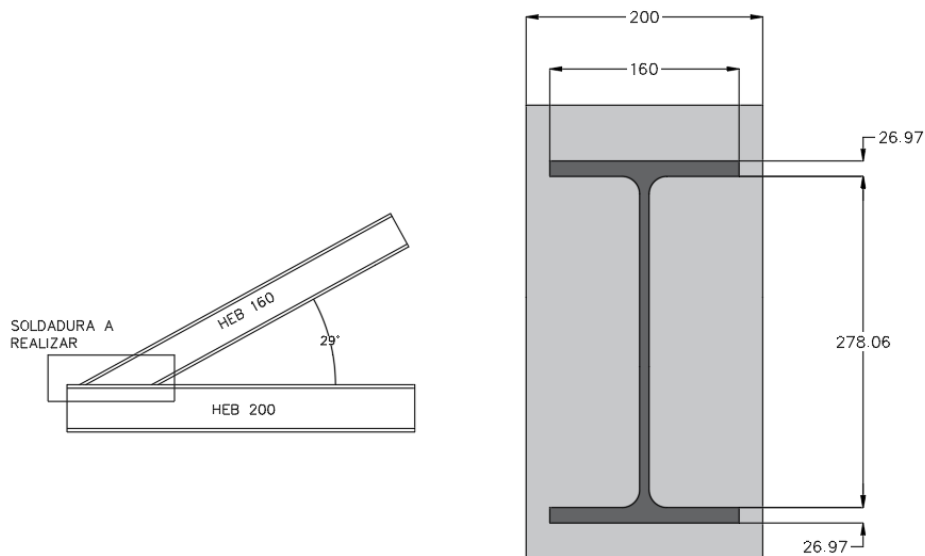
Dimensiones del perfil a soldar. Fuente: autor
